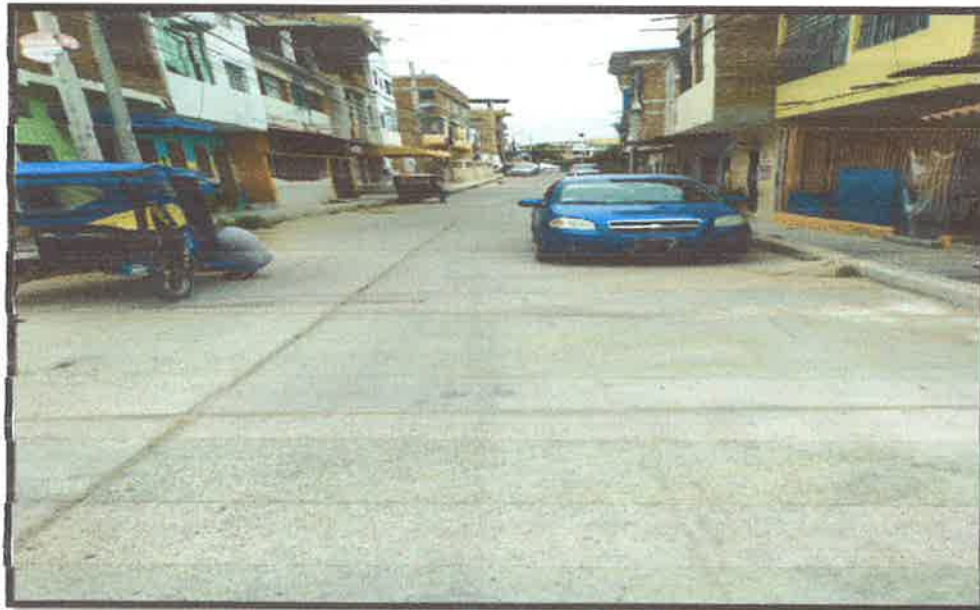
Pavimento en Buenas Condiciones - Calle Miraflores
